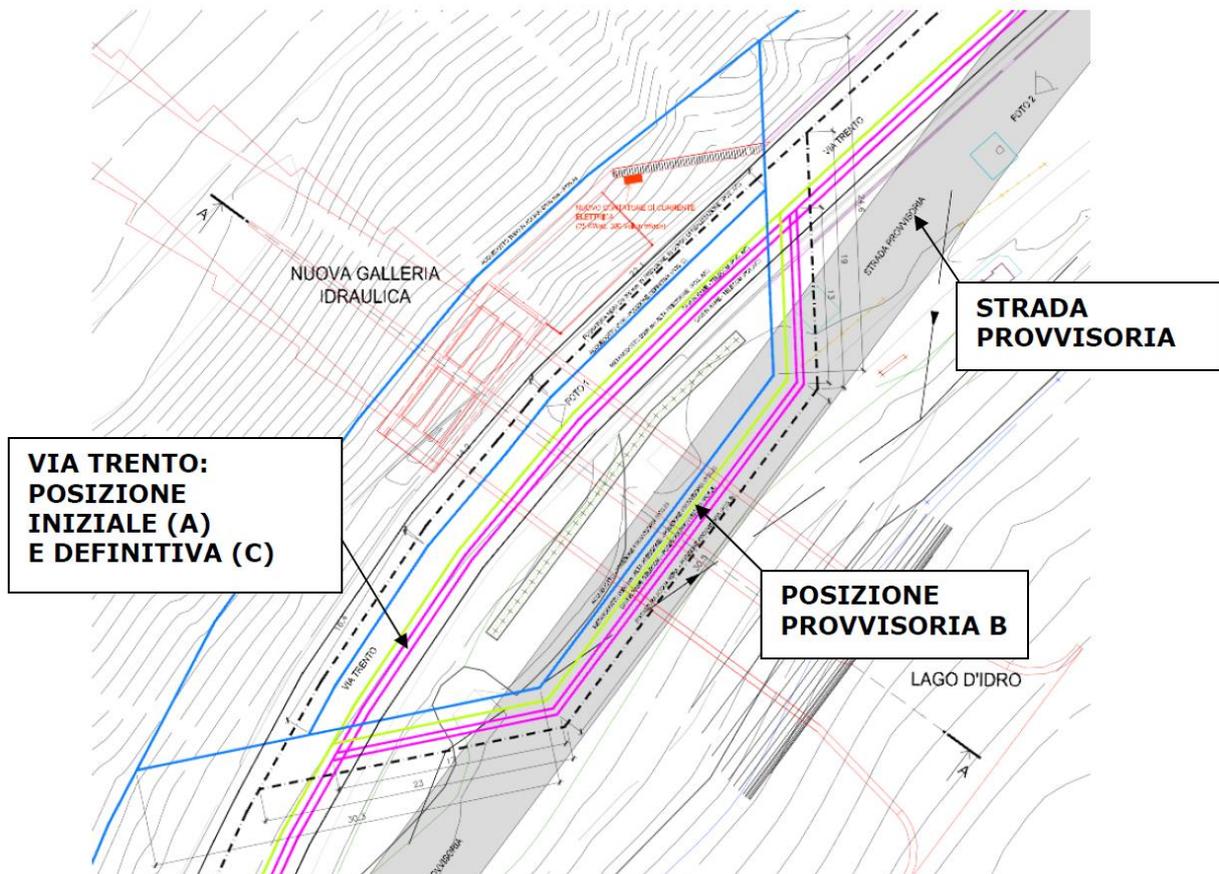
Planimetria con indicato lo spostamento dei sottoservizi in fase provvisoria dalla posizione (A) alla posizione (B), e in fase definitiva dalla posizione (B) alla posizione (C).
